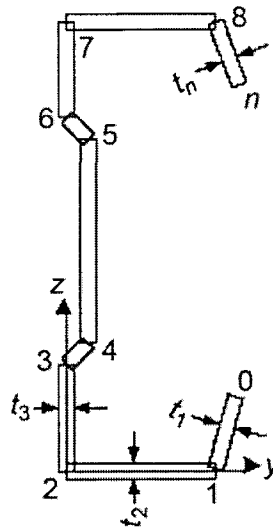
Вузлові з'єднання поперечного перерізу
